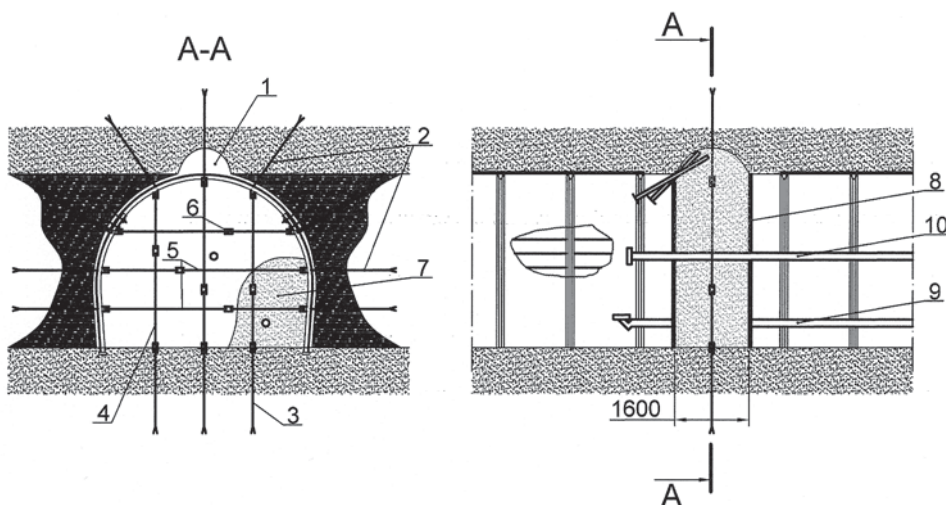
Конструкция безврубовой взрывоустойчивой перемычки: 1 — выемка для установки контрольной и нагнетательной трубы при подаче цементной смеси; 2 — дополнительные анкеры кровли и бортов выработки L = 2,4 м; 3 — дополнительные анкеры почвы L = 1 м; 4 — вертикальные связи из анкерных стержней; 5 — горизонтальные связи из анкерных стержней; 6 — соединительные муфты анкеров; 7 — изолирующая перемычка h = 1,6 м; 8 — доски и стойки опалубки; 9 — труба для пропуска воды; 10 — труба для отбора проб воздуха
